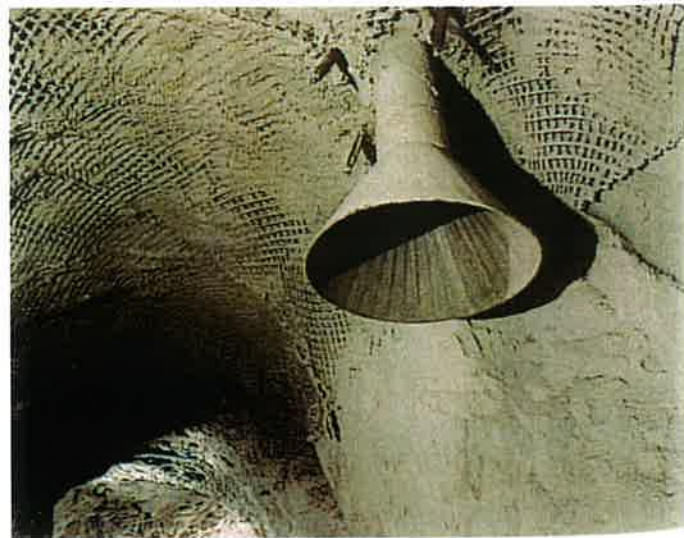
Vyústění těžebně-vtláčečeho vrtu
